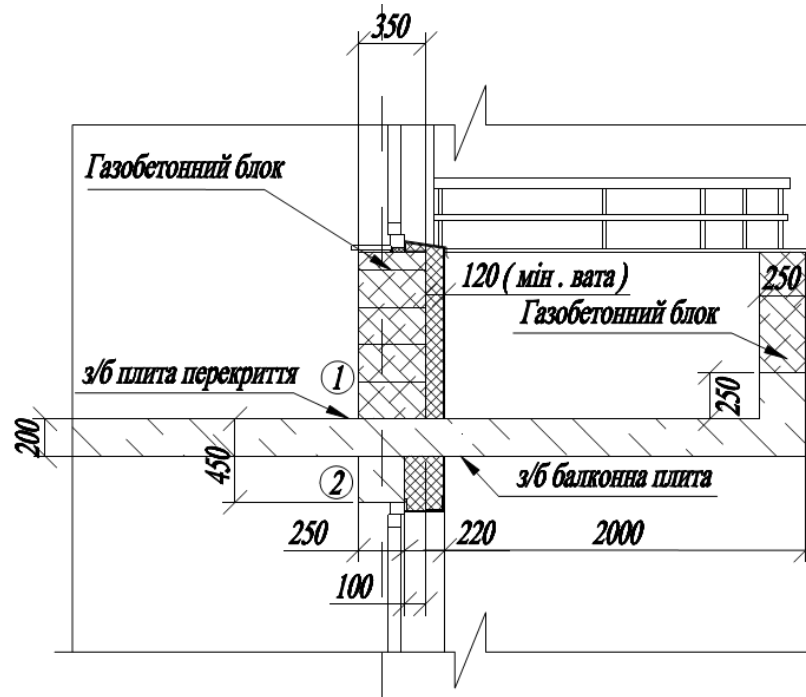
Конструктивне поєднання «з/б перекриття – зовнішня огорожувальна конструкція – балконна плита».
